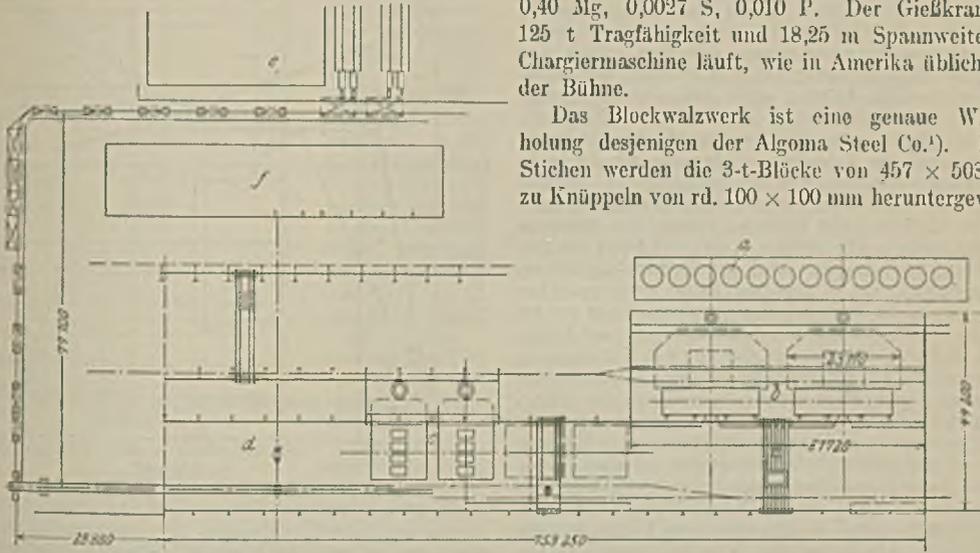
Lageplan der Kokomo Steel & Wire Co.
